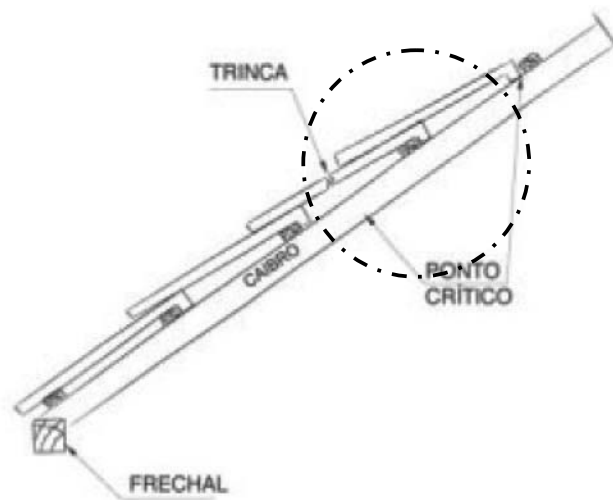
Ponto de infiltração onde existe trinca nas telhas ou má colocação destas.
